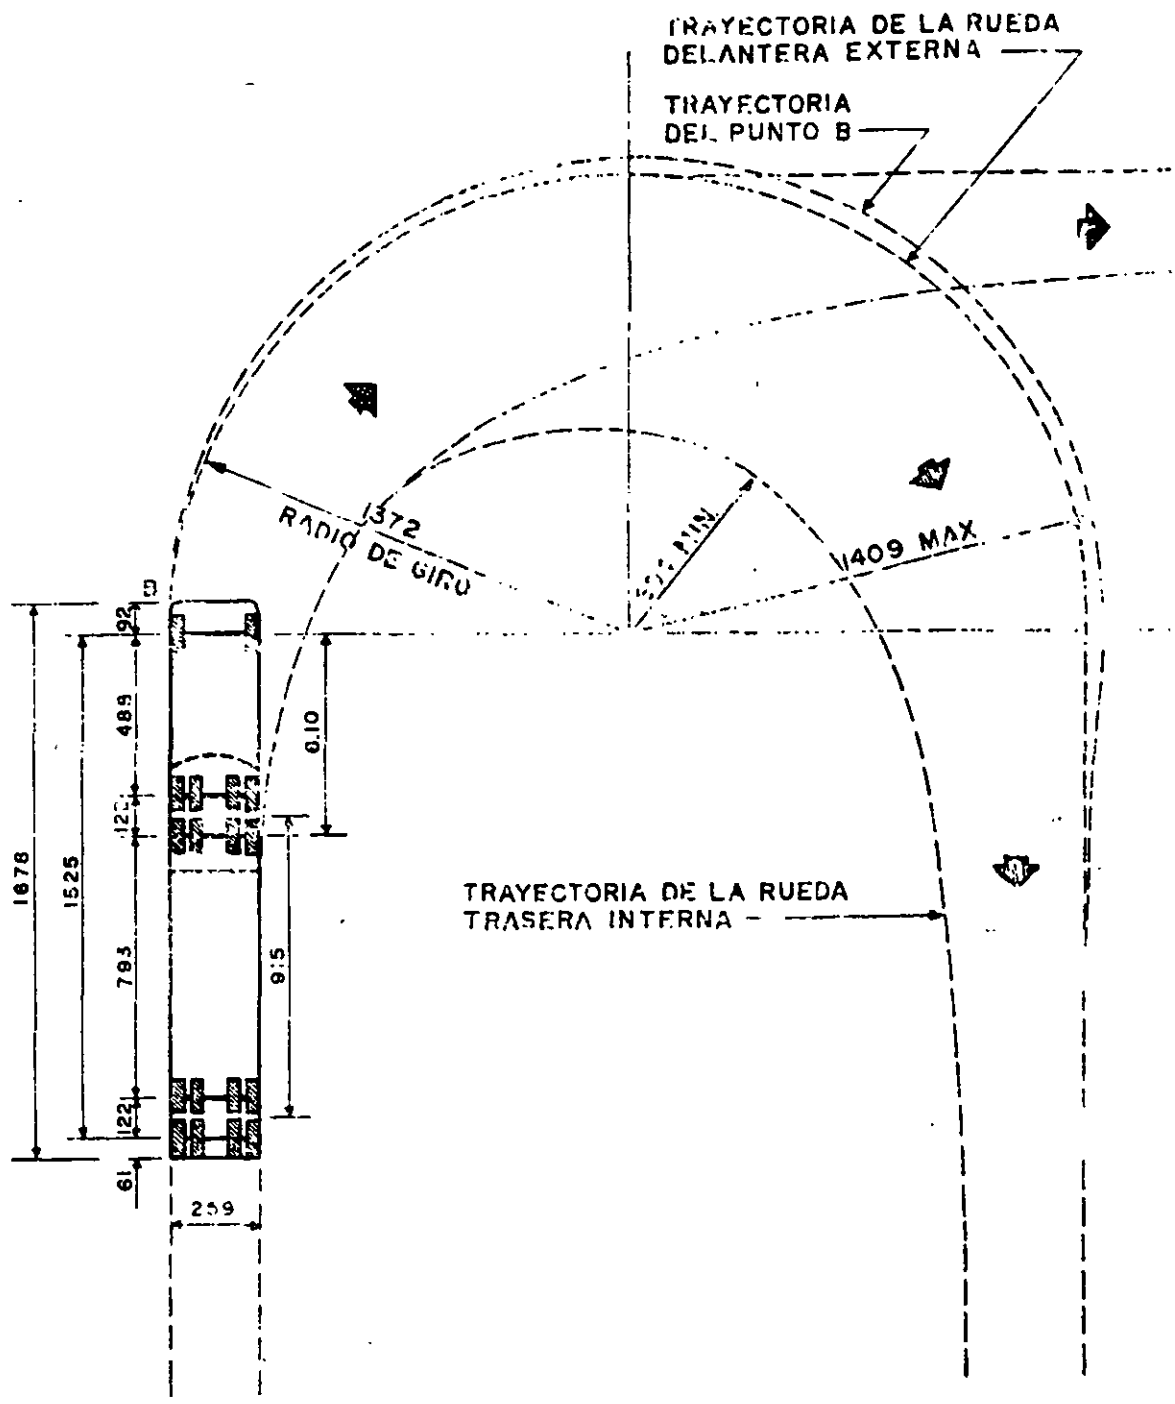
CARACTERÍSTICAS DEL VEHICULO DE PROYECTO DE-1325
